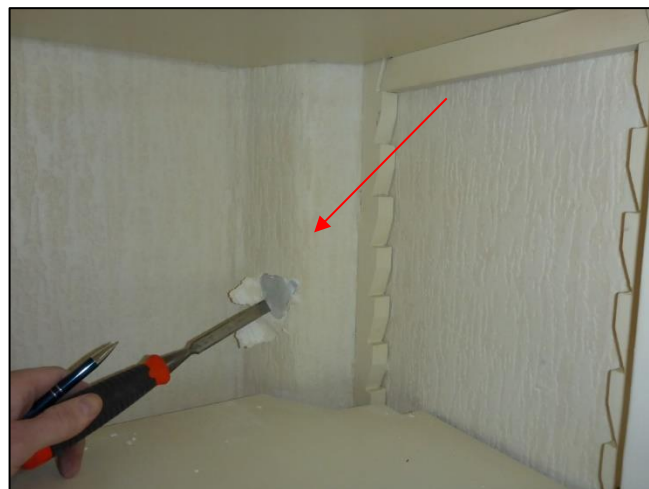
Woonkamer: Afvoerbuiss (Bron 4)
